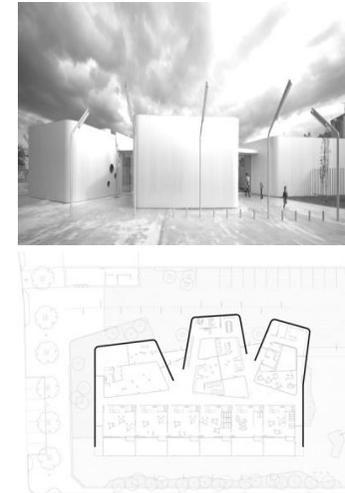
Imagen externa y planta de L'Escoleta en Palma
